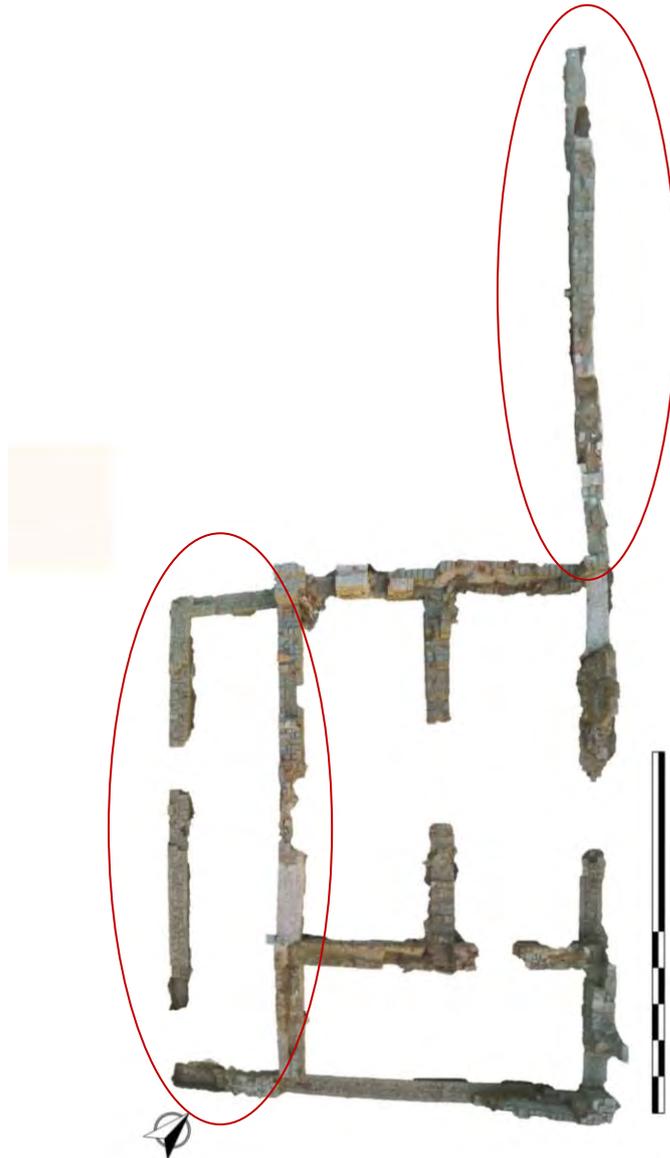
Planta del edificio en su segunda fase (Plano Grupo Vrbanitas).
